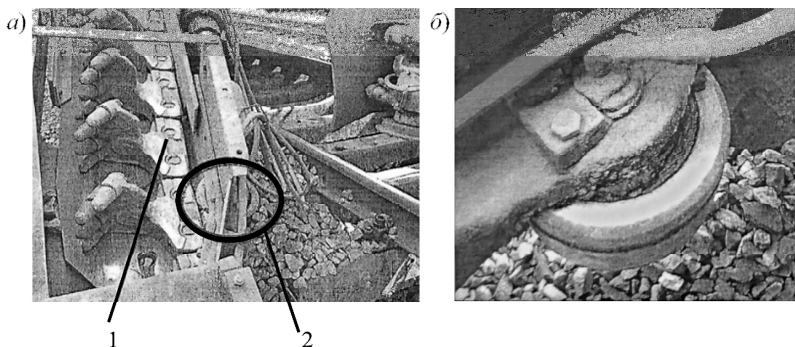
Общий вид баровой цепи (а) и направляющего ролика (б):
